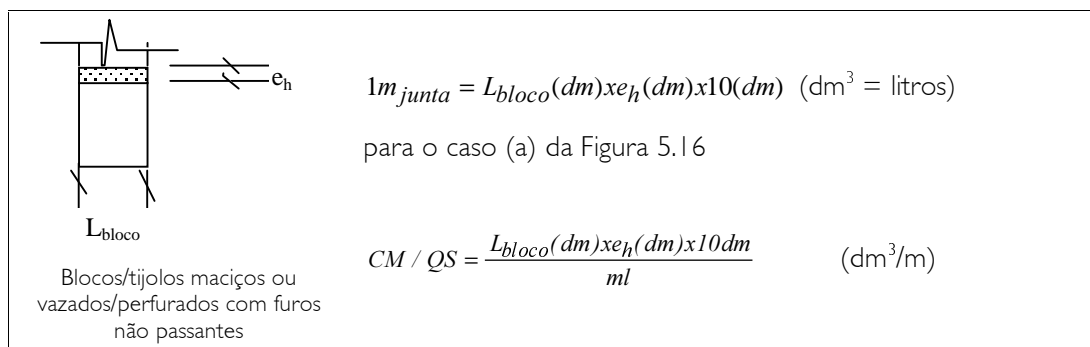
(a) – CM/QS para juntas horizontais – largura do bloco
